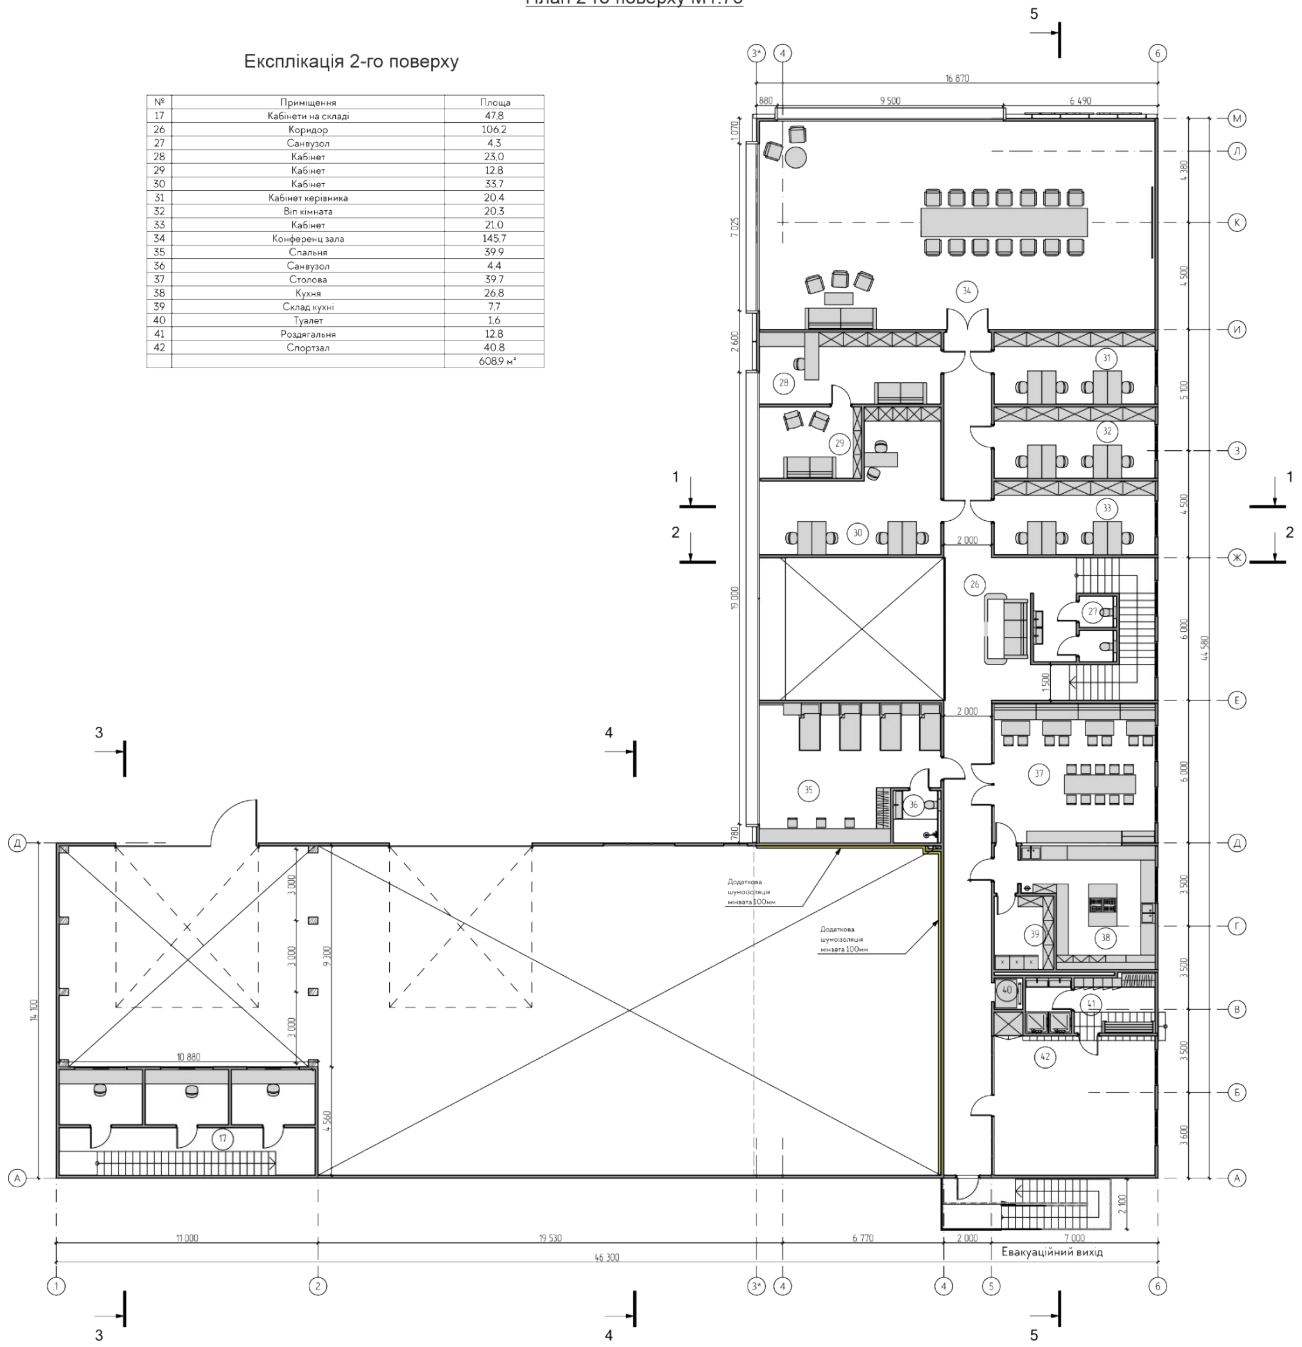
План 2-го поверху на відмітці +4.000
